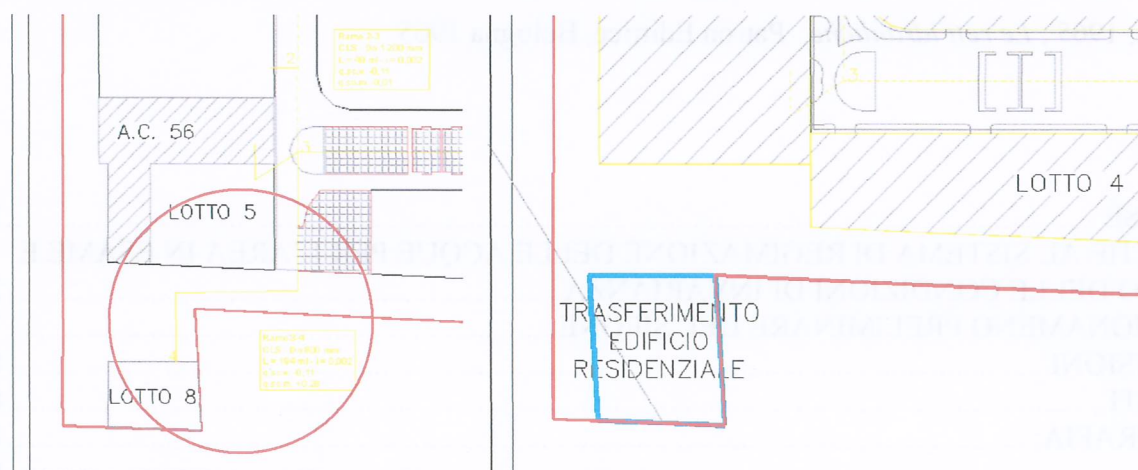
modifiche secondarie alla viabilità interna al lotto nella versione precedente (sinistra) e attuale(destra).
